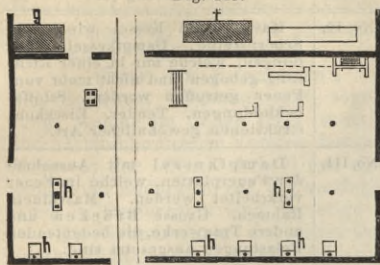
A. u. F. Schnellhämmer. D. u. G. Hammer von 0,25 t. drei Dampfhammern untergebracht sind. Am linksseitigen Ende befinden sich die Ventilatoren (S. 144) für die Feuer, ferner einige Werkzeug-Maschinen, Schleifsteine usw., welche von einer in der Mitte der kurzen Wand angebrachten Dampfmaschine getrieben werden. Am rechtsseitigen Ende liegen: 1 Bureau-, 1 kleiner und 1 grosser Magazin-Raum, der zugleich eine Ketten-Probir-Maschine aufnimmt. Das Dach ist aus 2 Satteldächern mit Eisen-Bindern hergestellt, deren Durchzüge horizontal gelegt und, in steifer Konstruktion, als Laufschienen für Katzen von 250 kg Tragfähigkeit, zur Bedienung der Hämmer und Schmiedefeuer ausgebildet sind.
